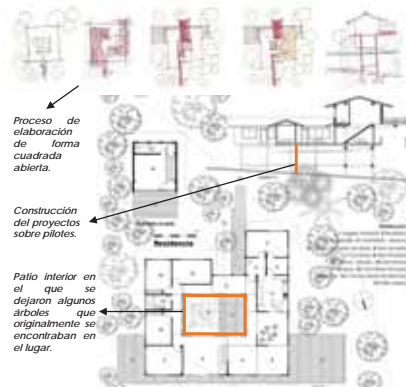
Bocetos iniciales, Planos de planta y corte.
